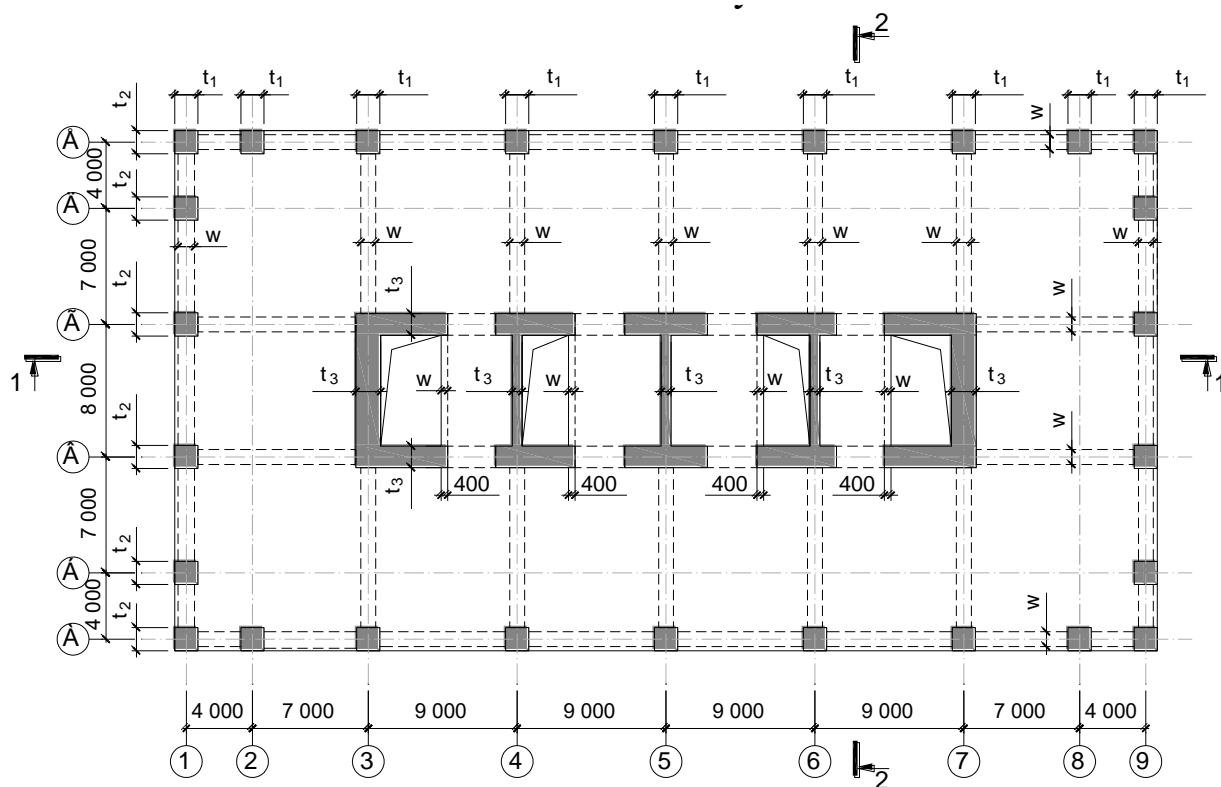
Схематические планы подземных и надземных этажей здания
